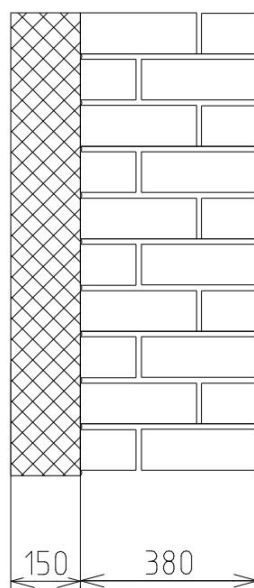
Эскиз утепленной стены здания ЗРУ-1
